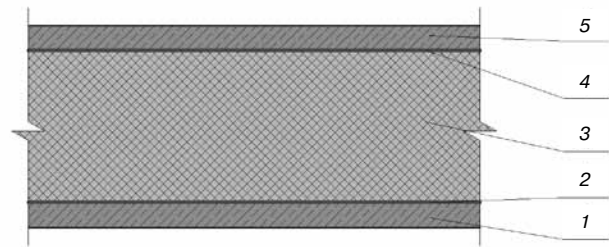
Сечение конструкции: 1, 5 – наружные бетонные слои; 3 – внутренний теплоизоляционный слой; 2, 4 – слои гравелистого песка (или слои, армированные фиброй)
